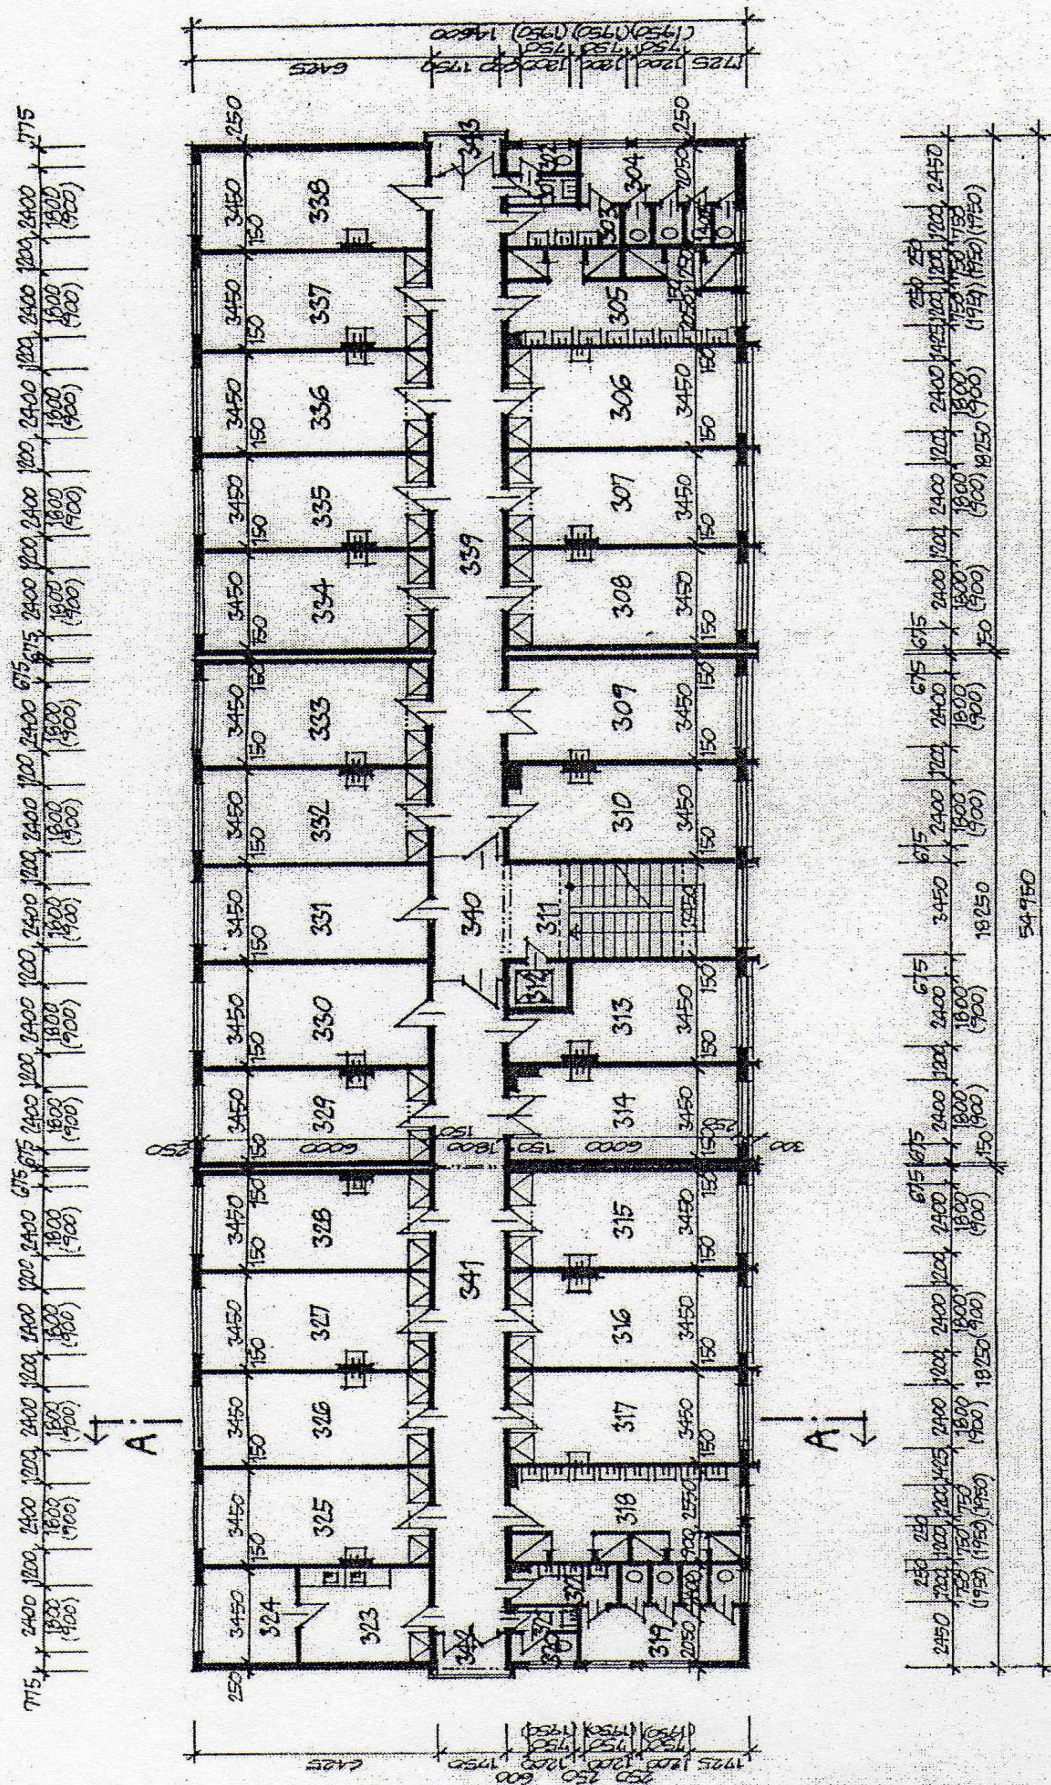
Stavební plán – Půdorys 1. nadzemního podlaží
